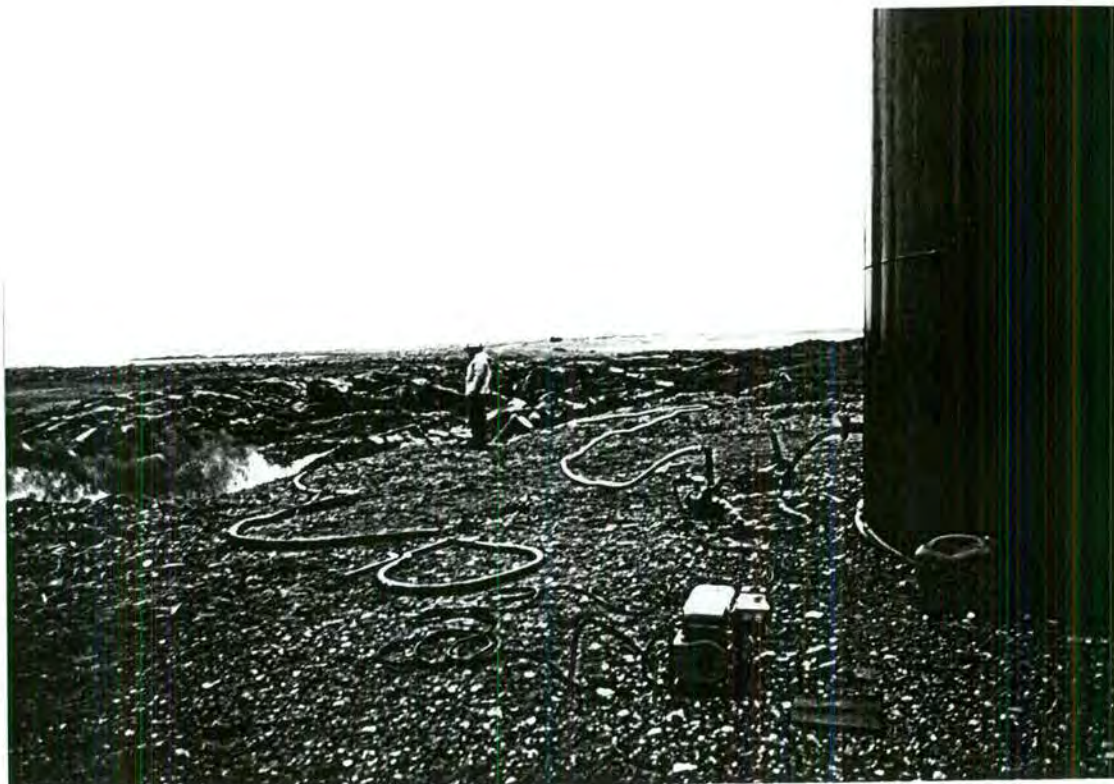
Pompe et génératrice pour vider un réservoir du site 410
